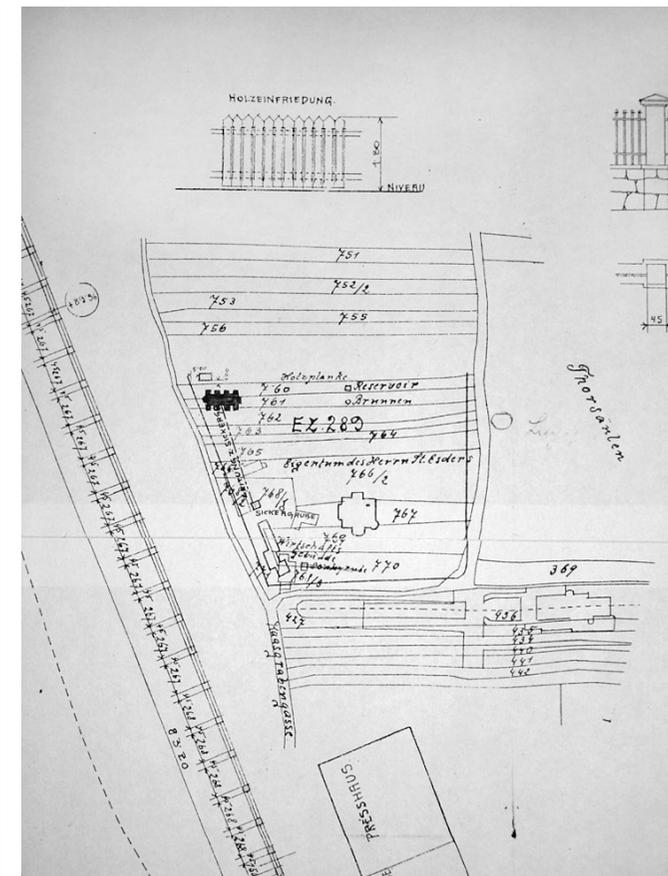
(rechts): Villa Esders. Situationsplan. Detail. 1911.
